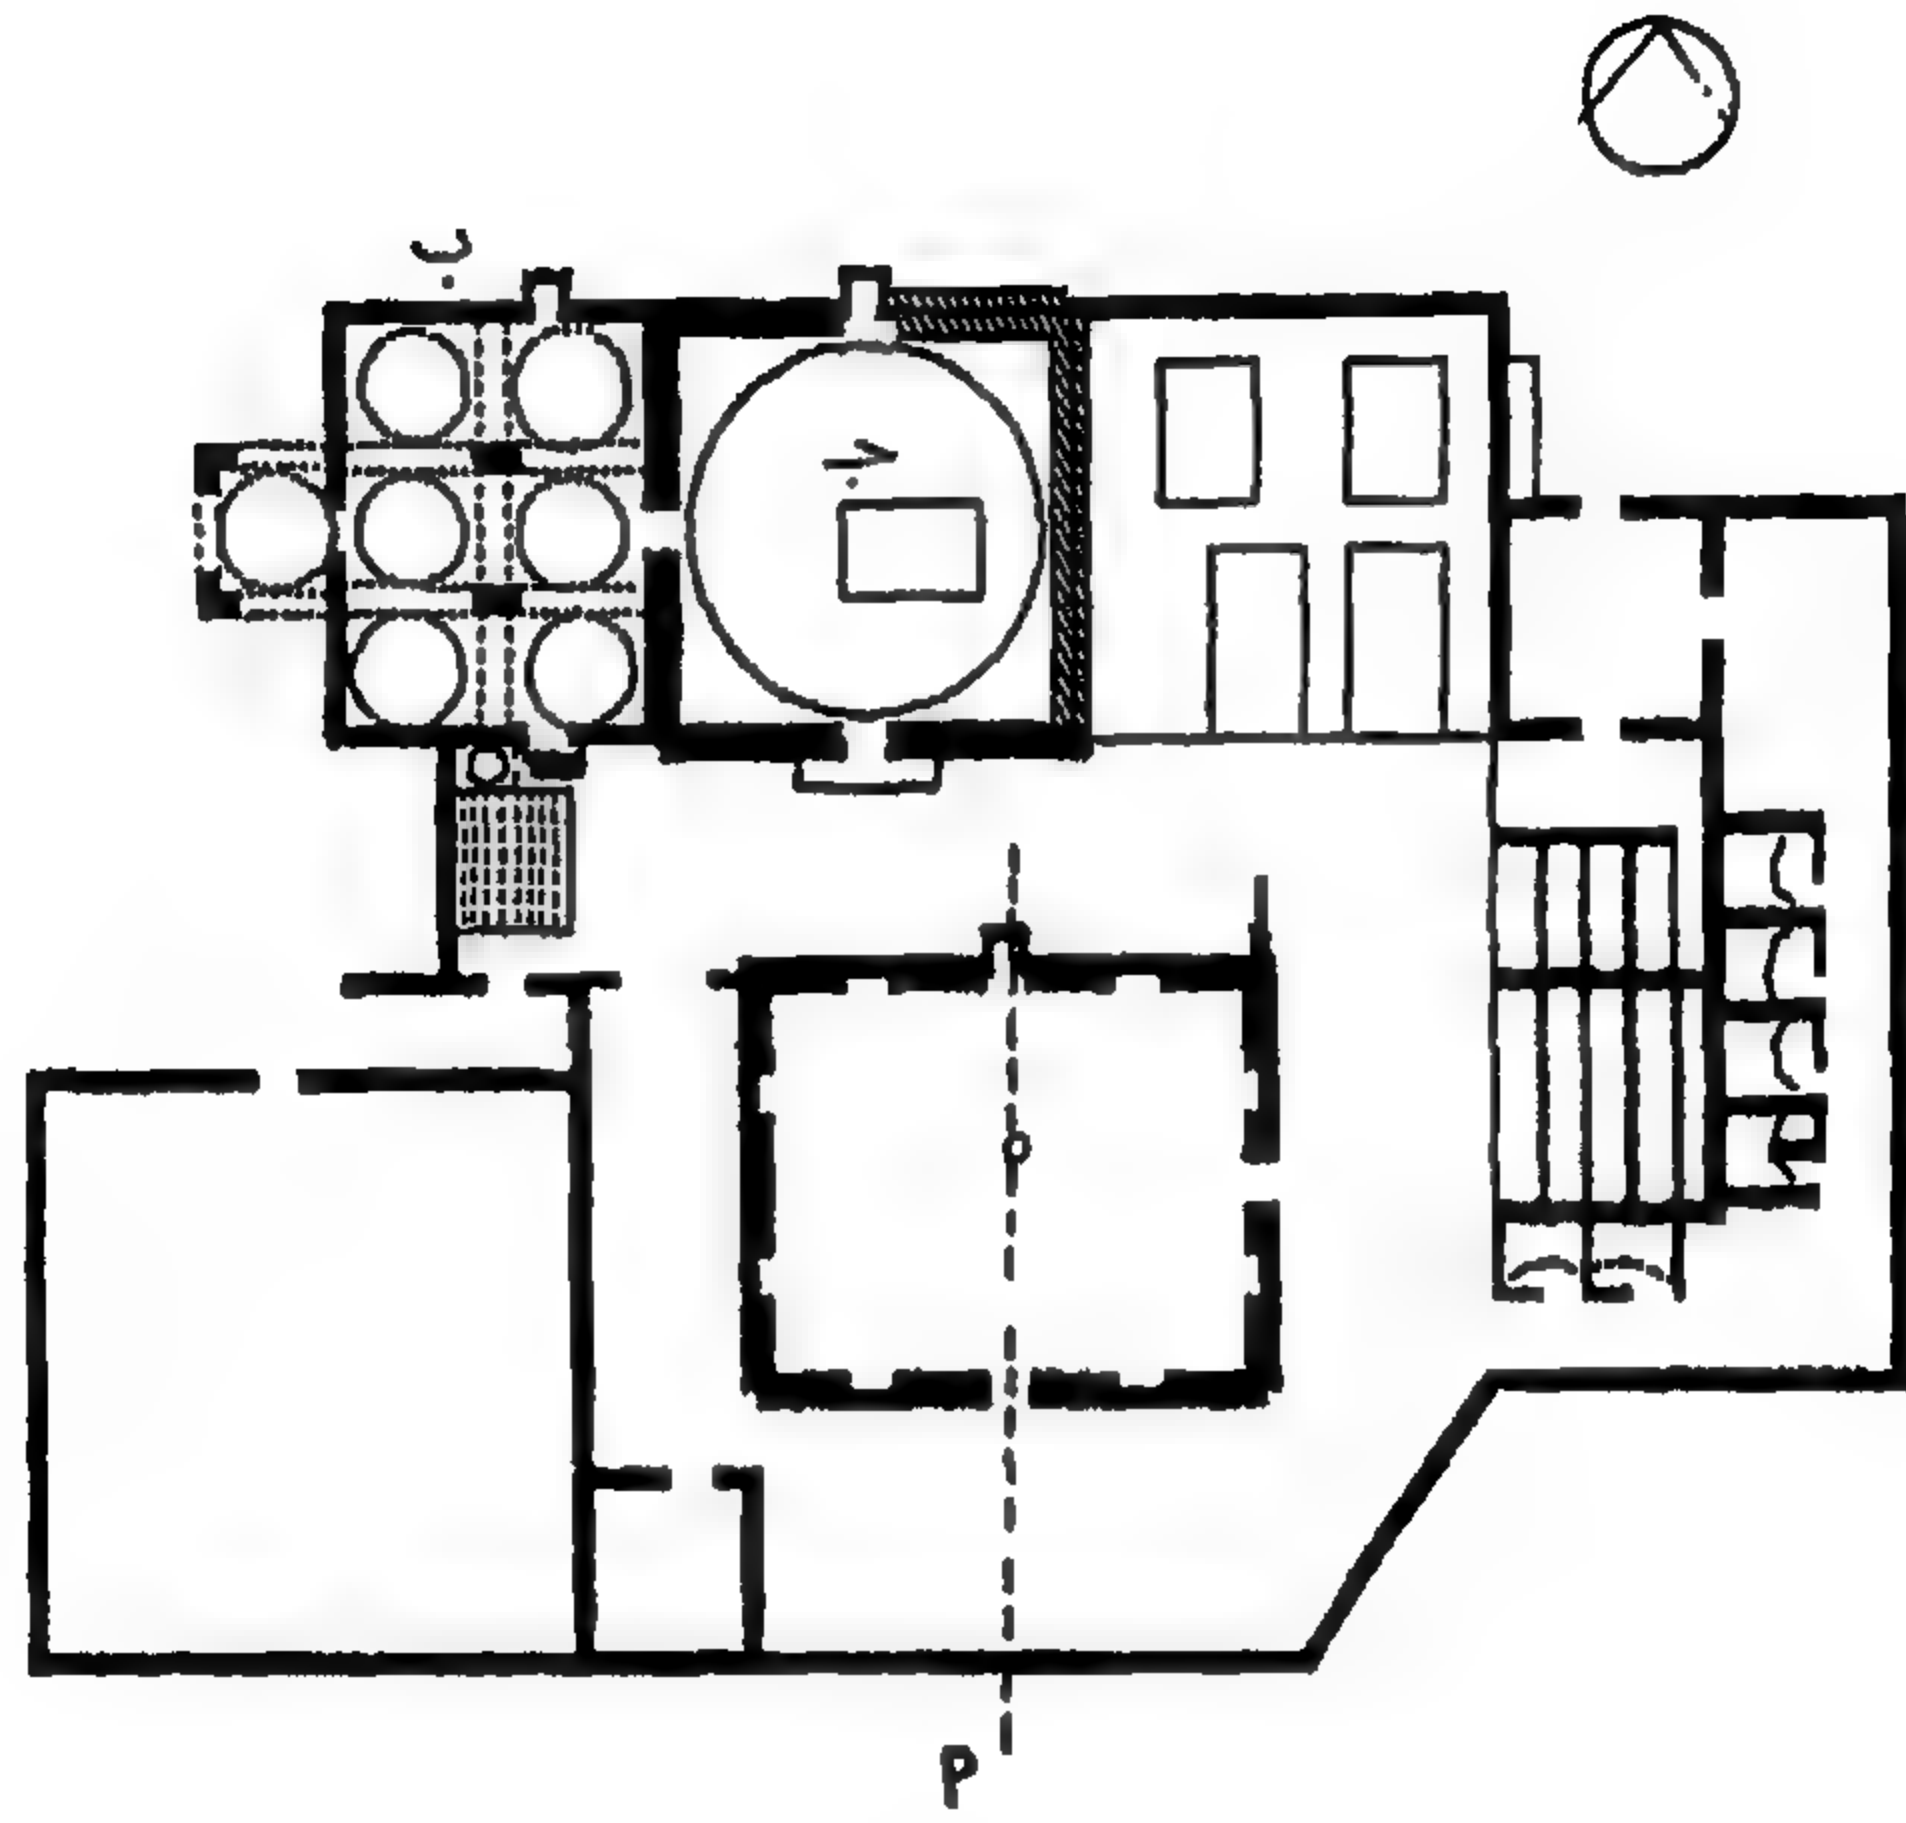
مسقط أفقى للمدرسة الياقوتية برباط البريهى
